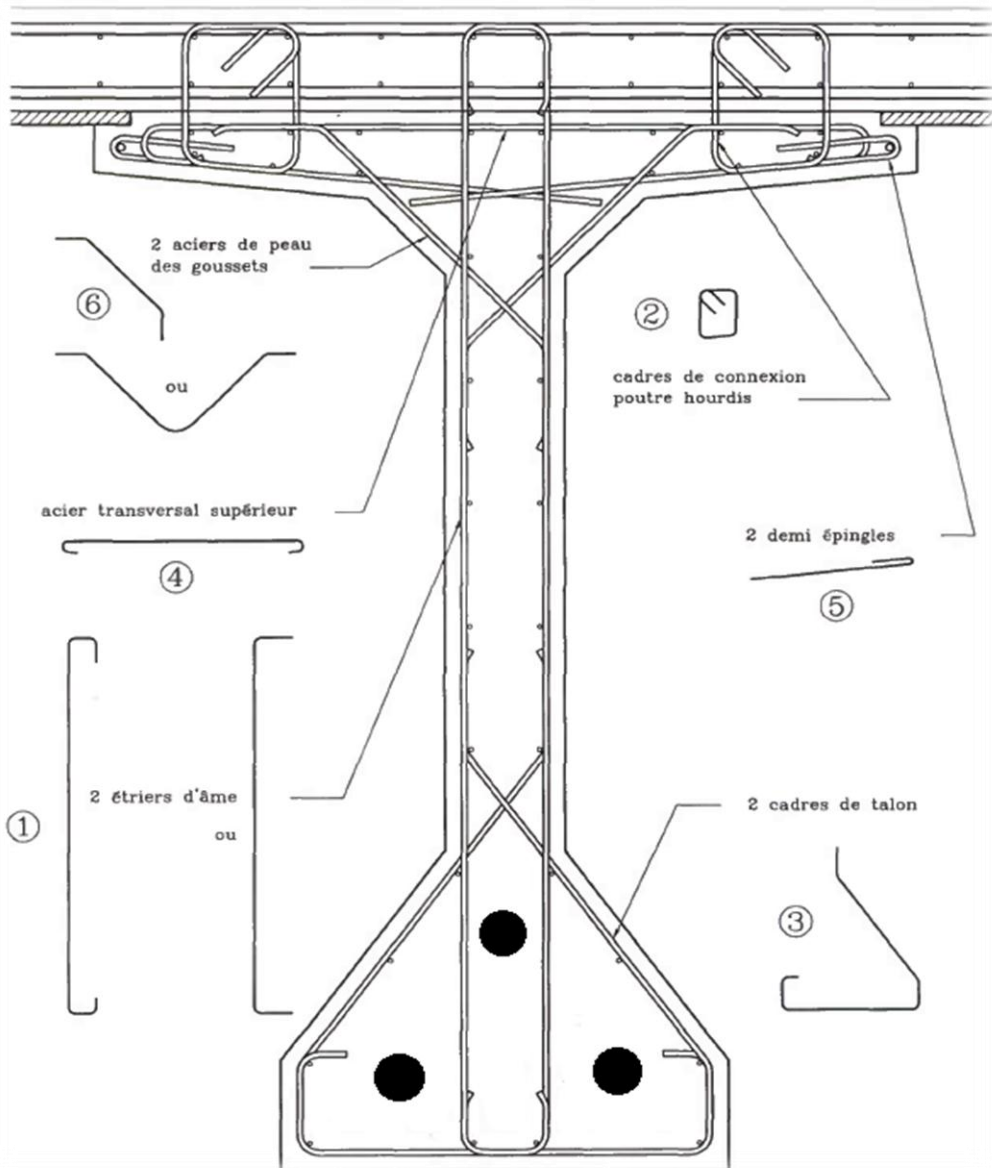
principe de ferrailage d'une poutre en béton précontraint
